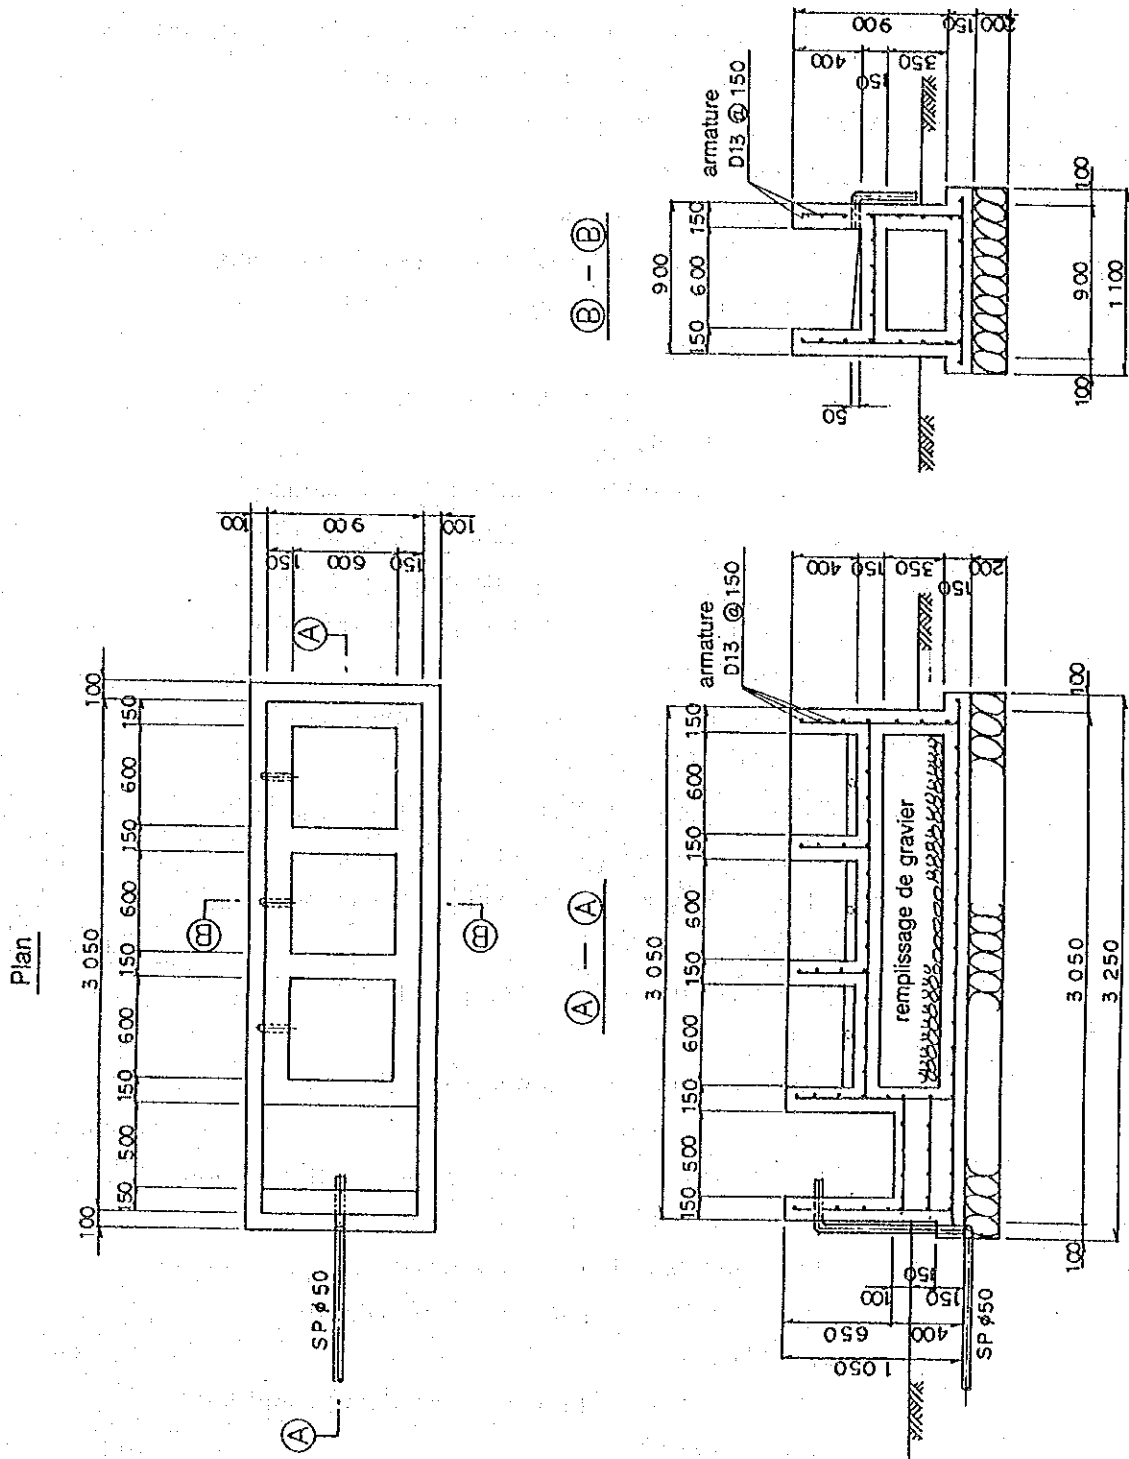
Plan détaillé du lavoir S = 1 : 30
